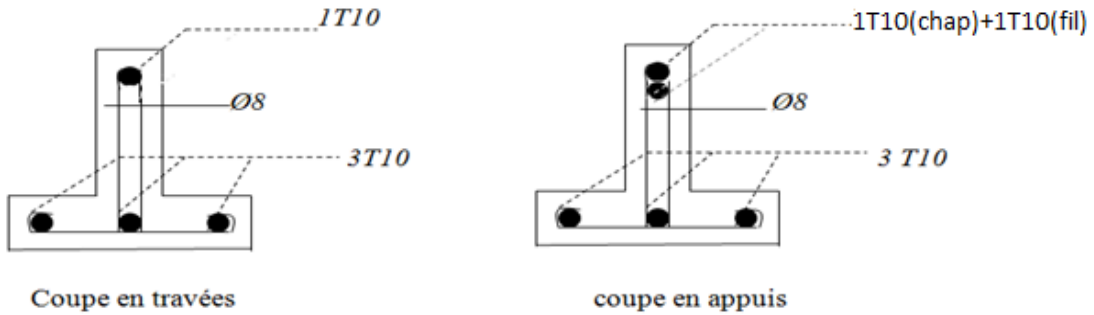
Schémas ferrailage des poutrelles Plancher Terrasse (Poutrelles de rive).
